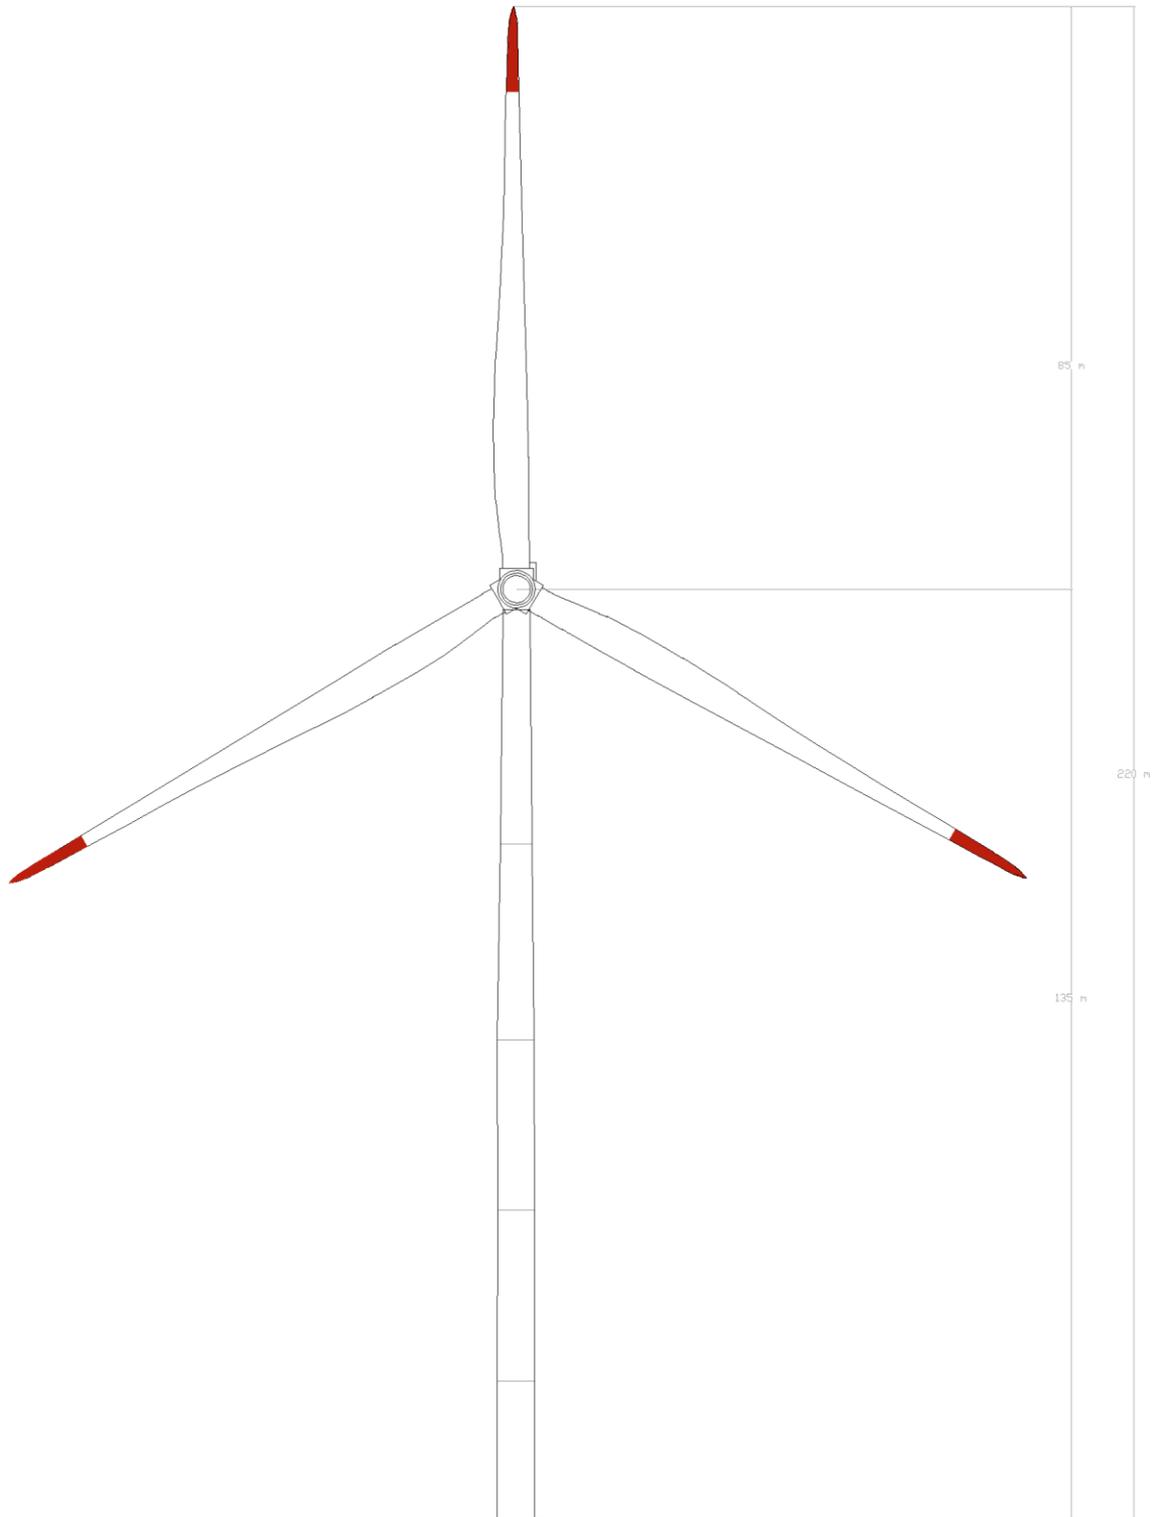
Segnalazione cromatica su prospetto frontale dell'aerogeneratore
